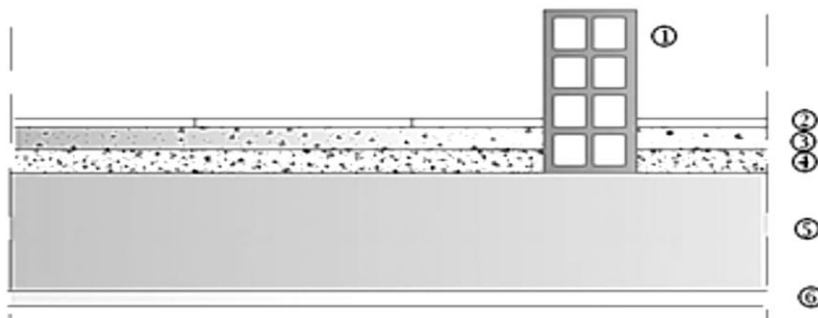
b : coupe verticale d'un plancher d'étage courant
